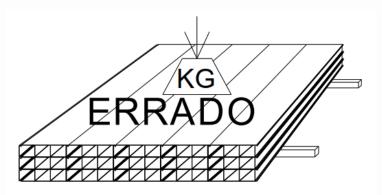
Forma errada de armazenamento dos painéis de PVC
